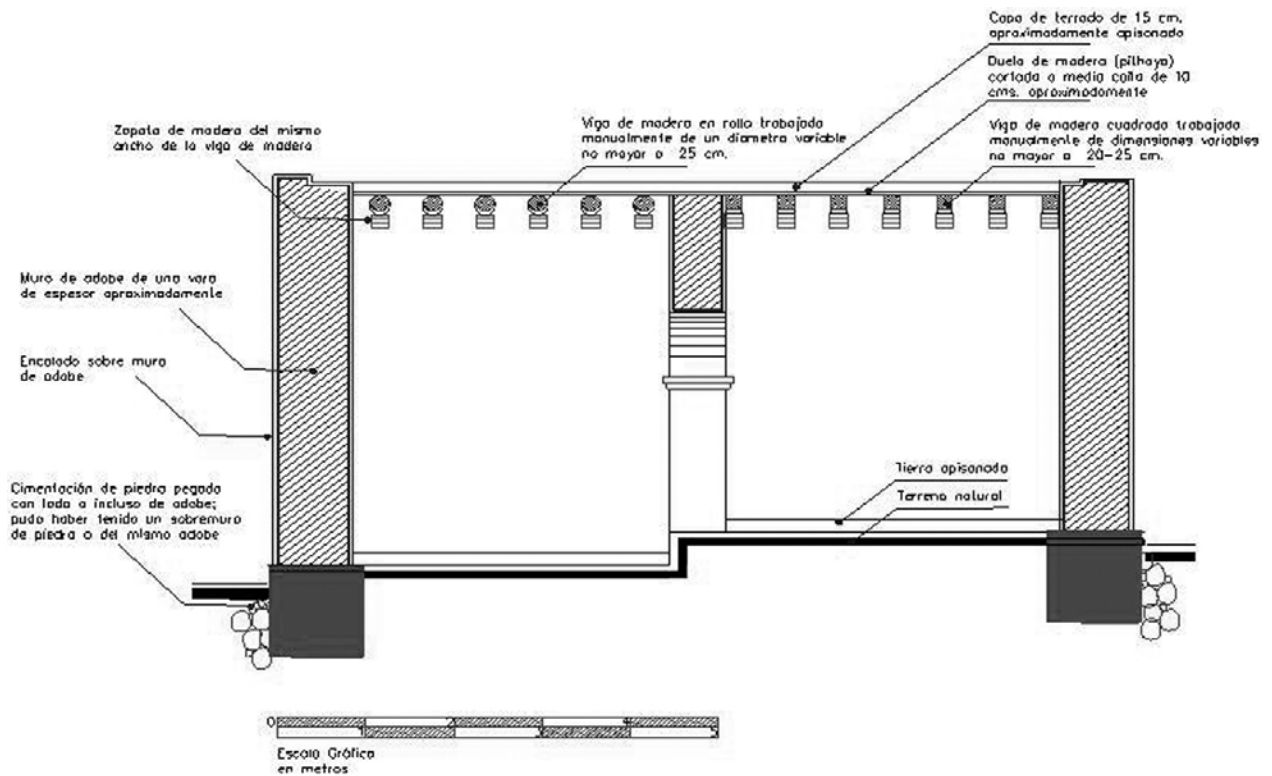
Corte esquemático basado en la iglesia de Ónavas; cimentación de piedra sobre el nivel del terreno, muros de adobe, techumbre a base de vigas de madera de diferentes tipos asentadas sobre zapatas de madera característica de la arquitectura de las iglesias de la provincia, duela de madera y terrado; sistema constructivo que se fue actualizando con la introducción de nuevos materiales a la provincia. Dibujo de Francisco Hernández Serrano.
